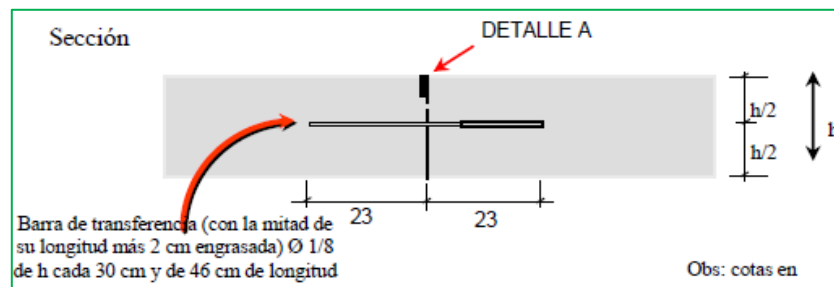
Junta Transversal de Construcción. (Ref. Bibliografía 5)
